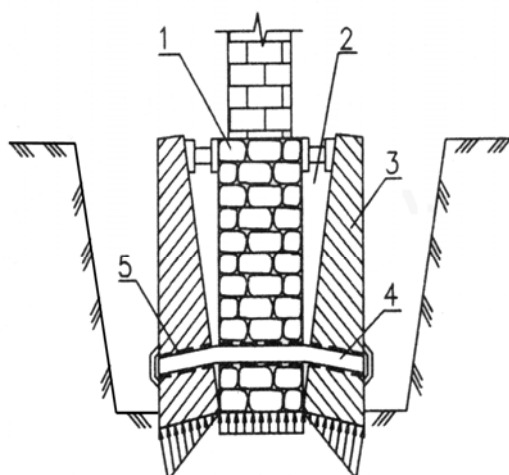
Усиление фундаментов дополнительными блоками, обжимающими грунты оснований при их повороте: 1 – существующий фундамент; 2 – щель, раскрываемая при повороте блоков; 3 – железобетонный блок; 4 – анкерное крепление; 5 – отверстия для анкеров
